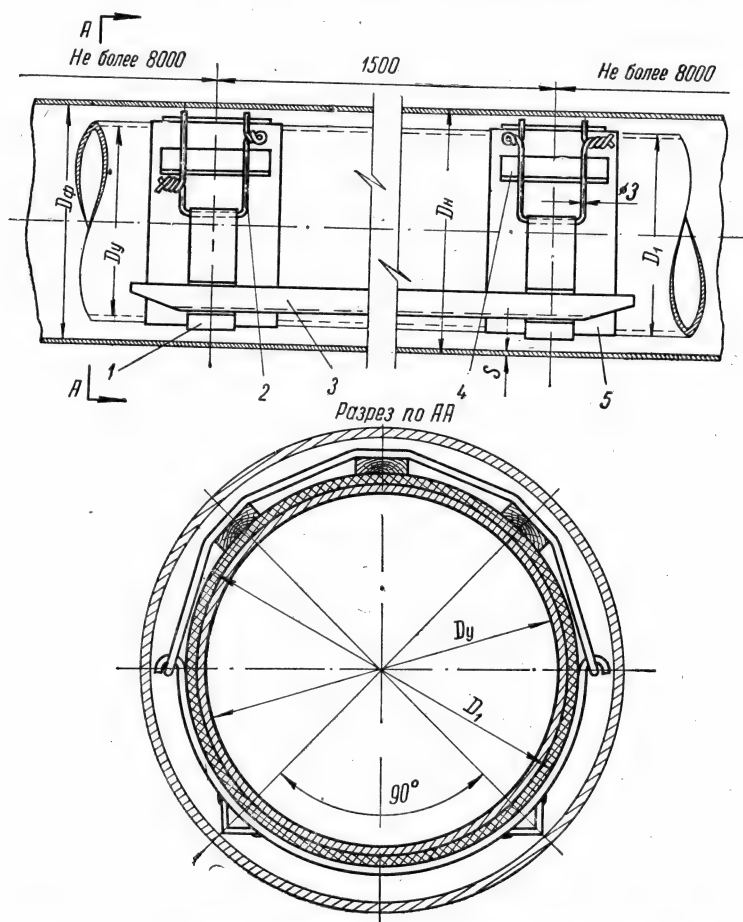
Конструкция опоры тип I с полозом из разнобокового уголка:
